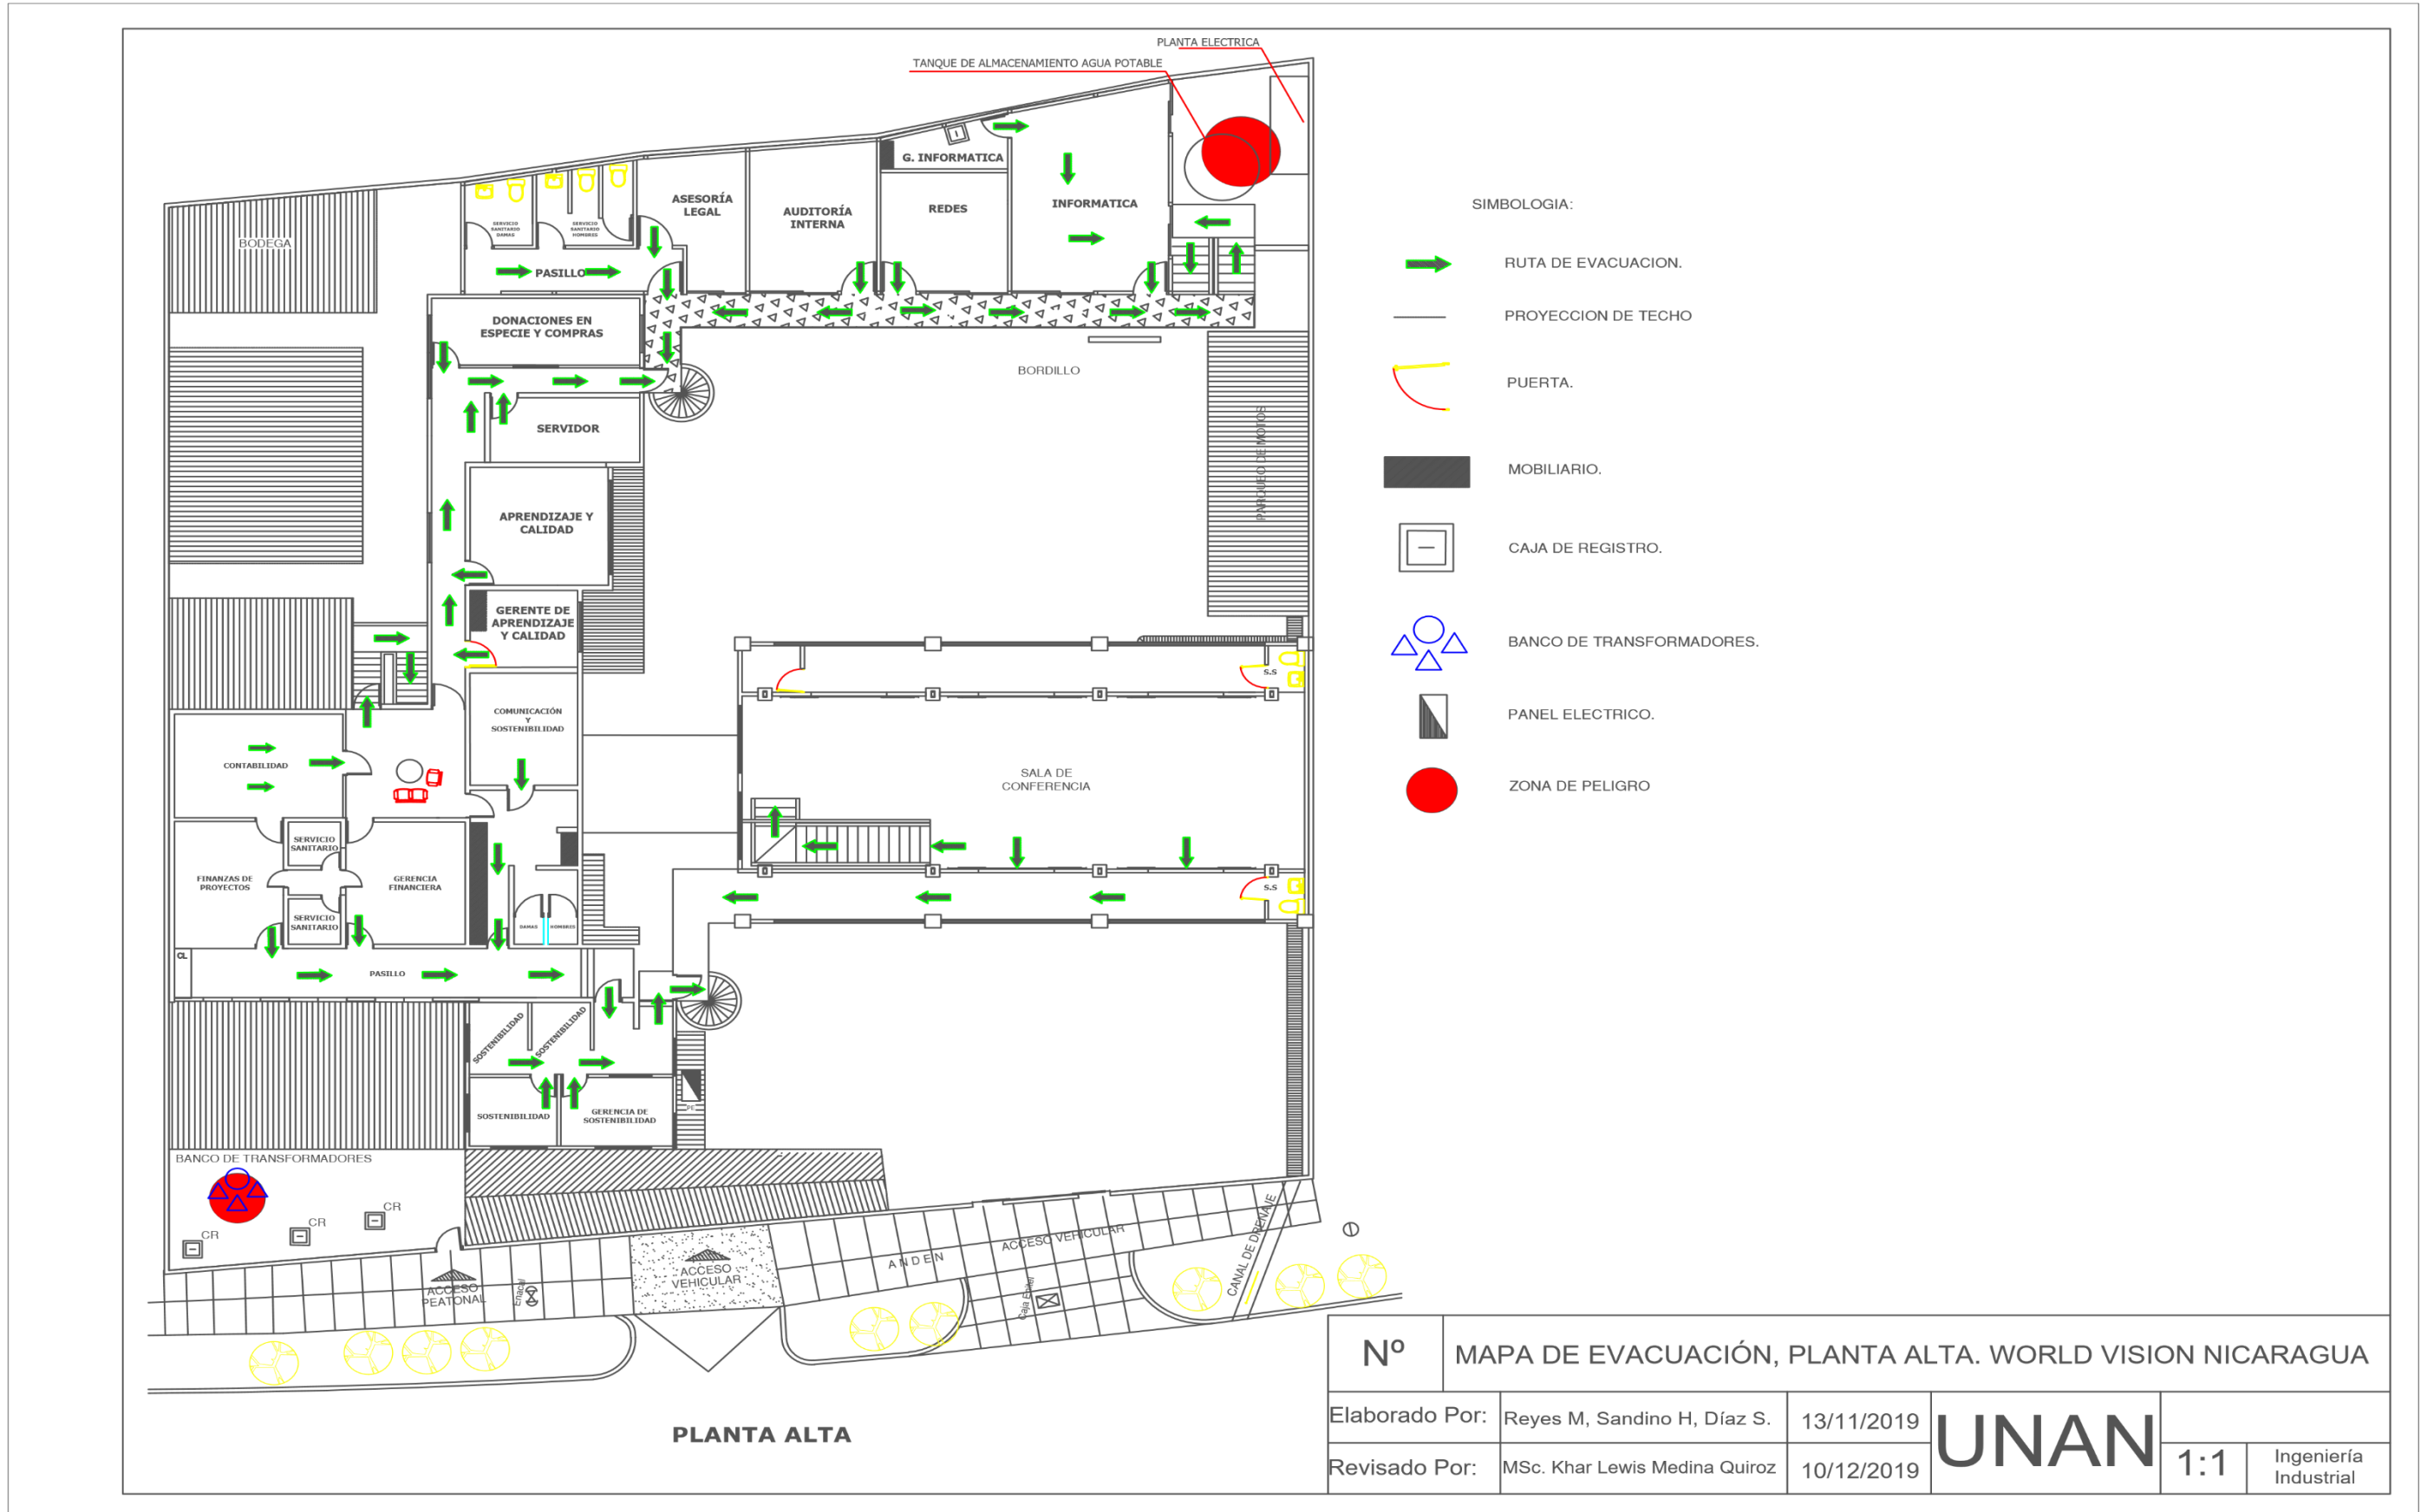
Ruta de Evacuación Propuesta, Planta Alta.
